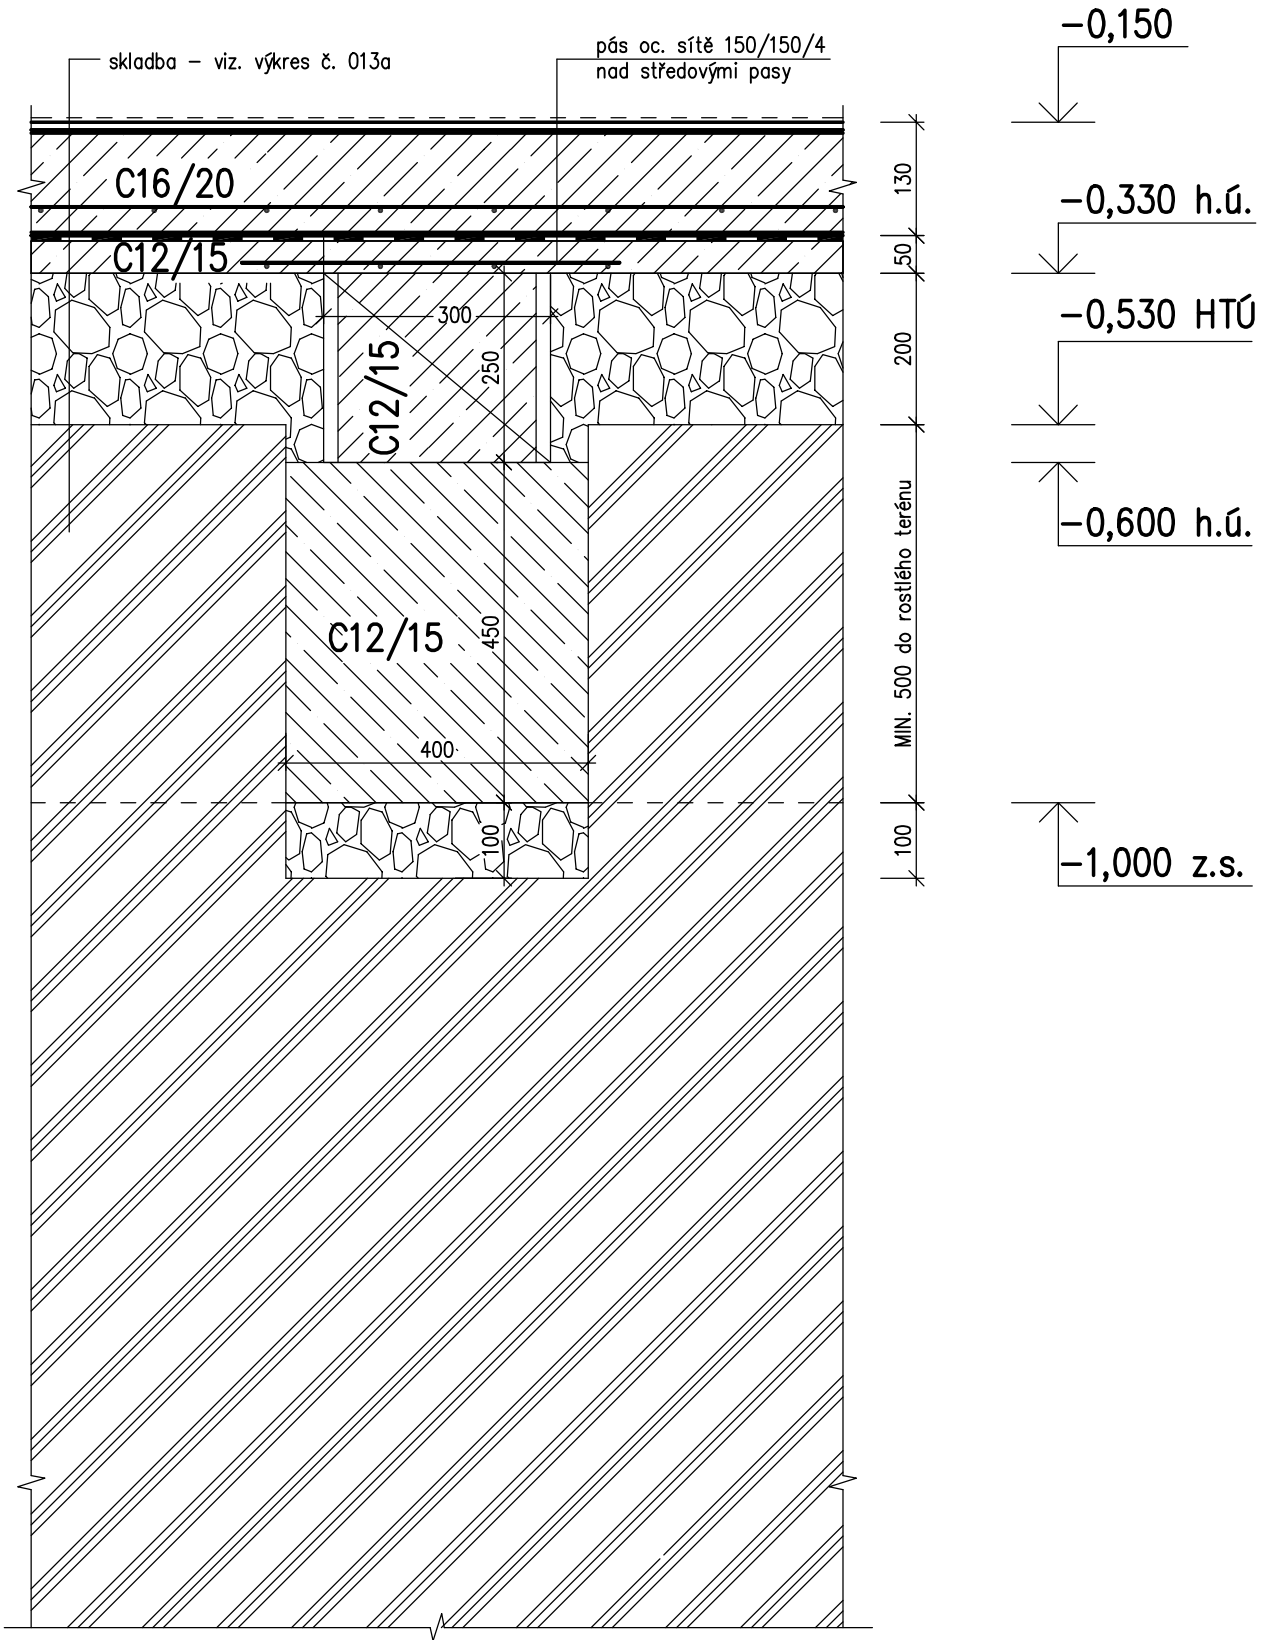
ÚPRAVA OKRAJE KONSTRUKCE
